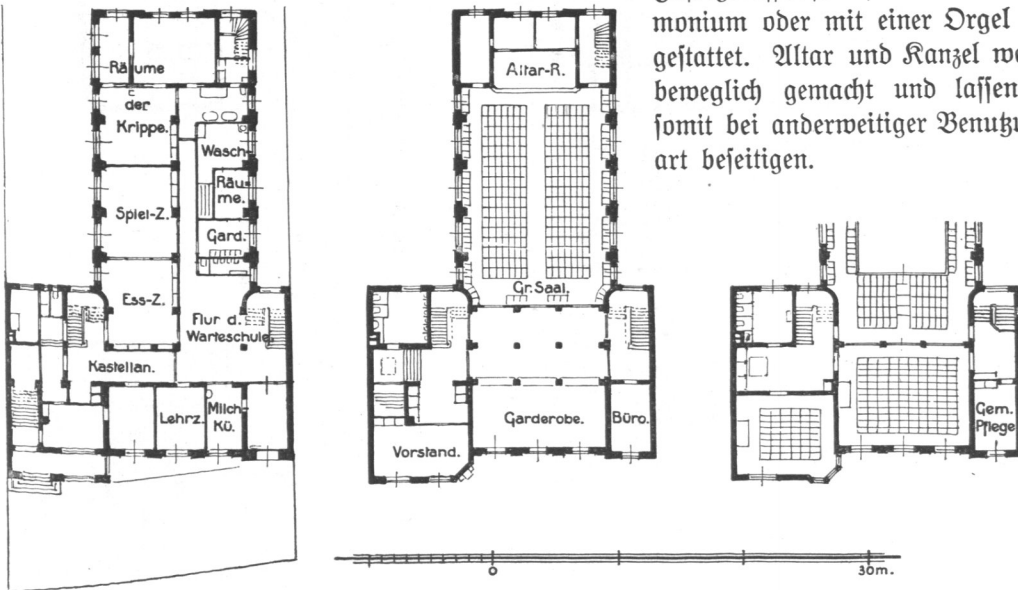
bis 165. Gemeindehaus Hoheluft, Grundrisse.
